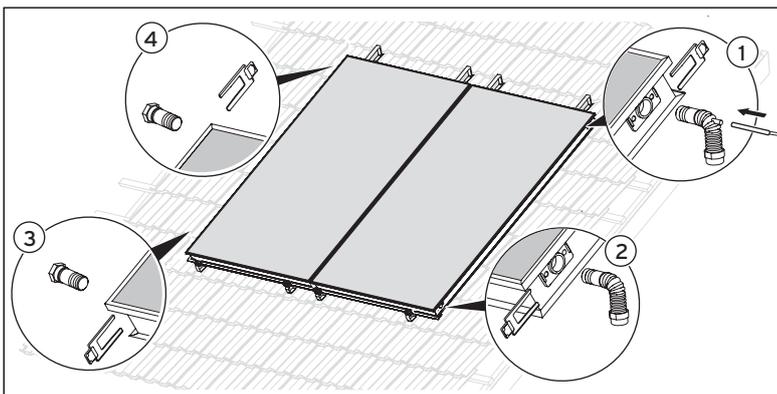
Montaggio dei collegamenti idraulici (1 - 5 collettori)
